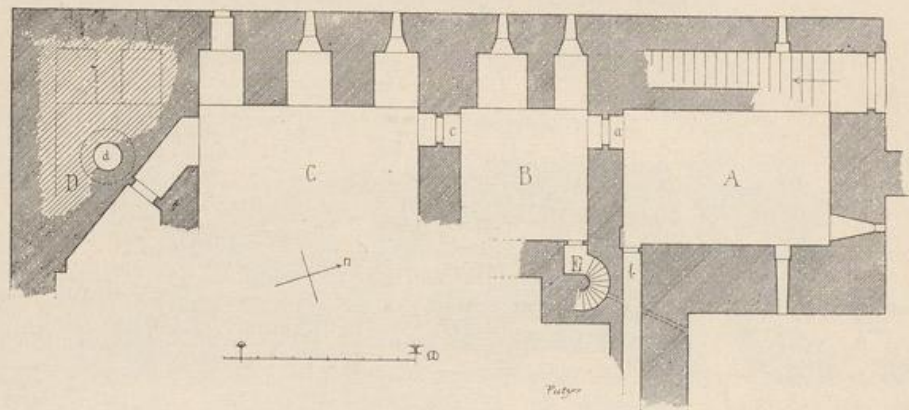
Kaiserswerth. Grundriss der Burg.
